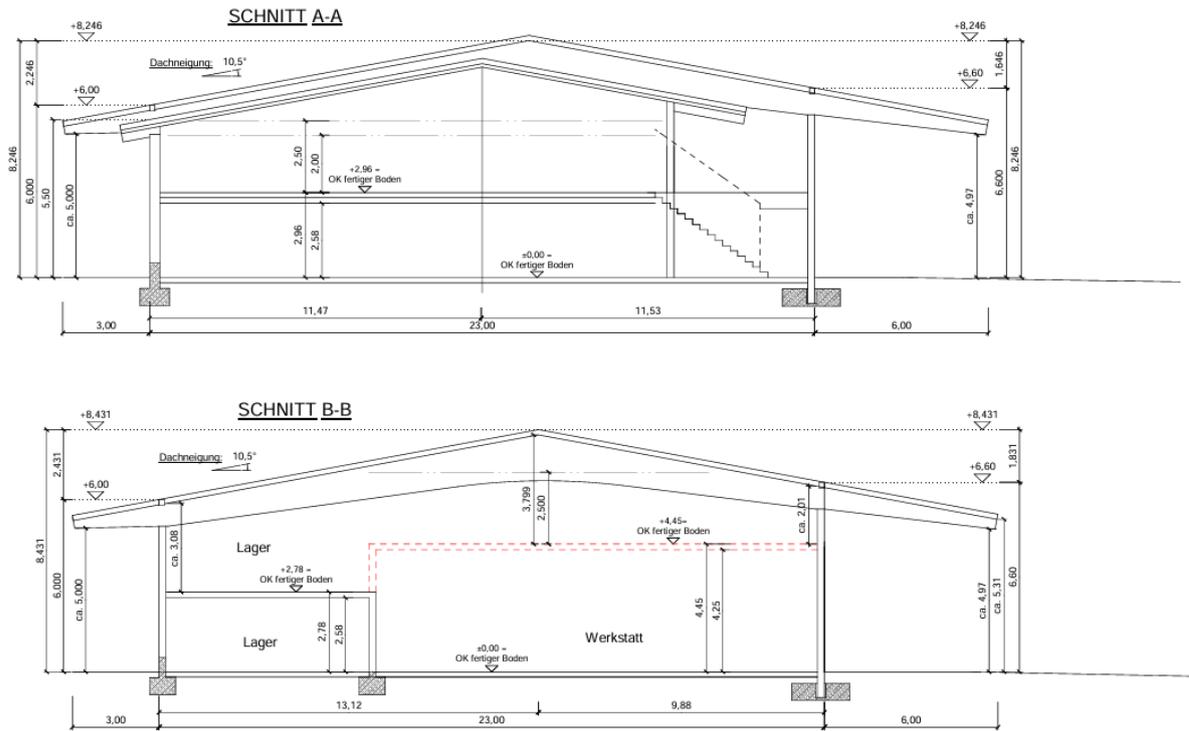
Bürogebäude mit dahinter liegender Werkstatt und Lagerhalle im nördlichen Bereich der Fläche o.M. (Römmelt Hallenbau)
